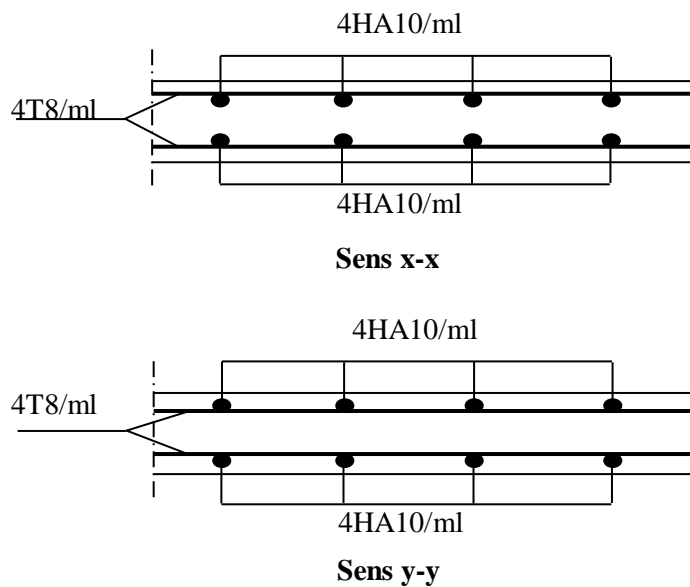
schéma de ferrailage de la dalle pleine de la salle machine
